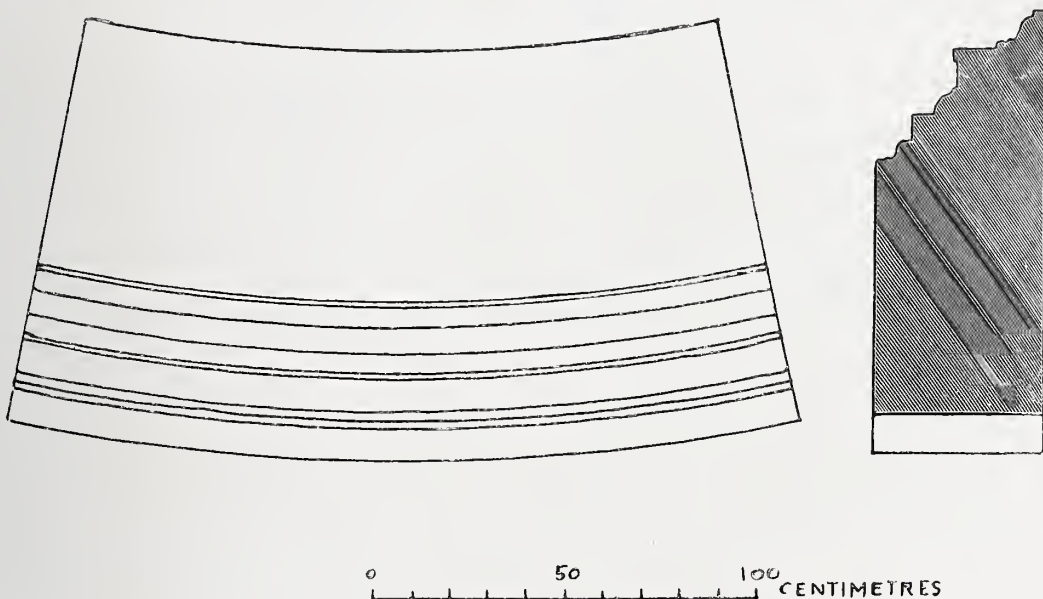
Cornicione della gran nicchia: pianta e sezione.
